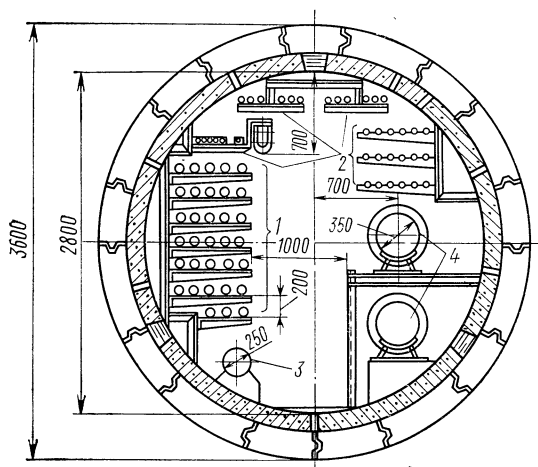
Схематический разрез круглого коллектора, в котором размещаются 33 кабеля связи, 36 силовых электрокабелей, одна водопроводная труба и две трубы теплосети:
